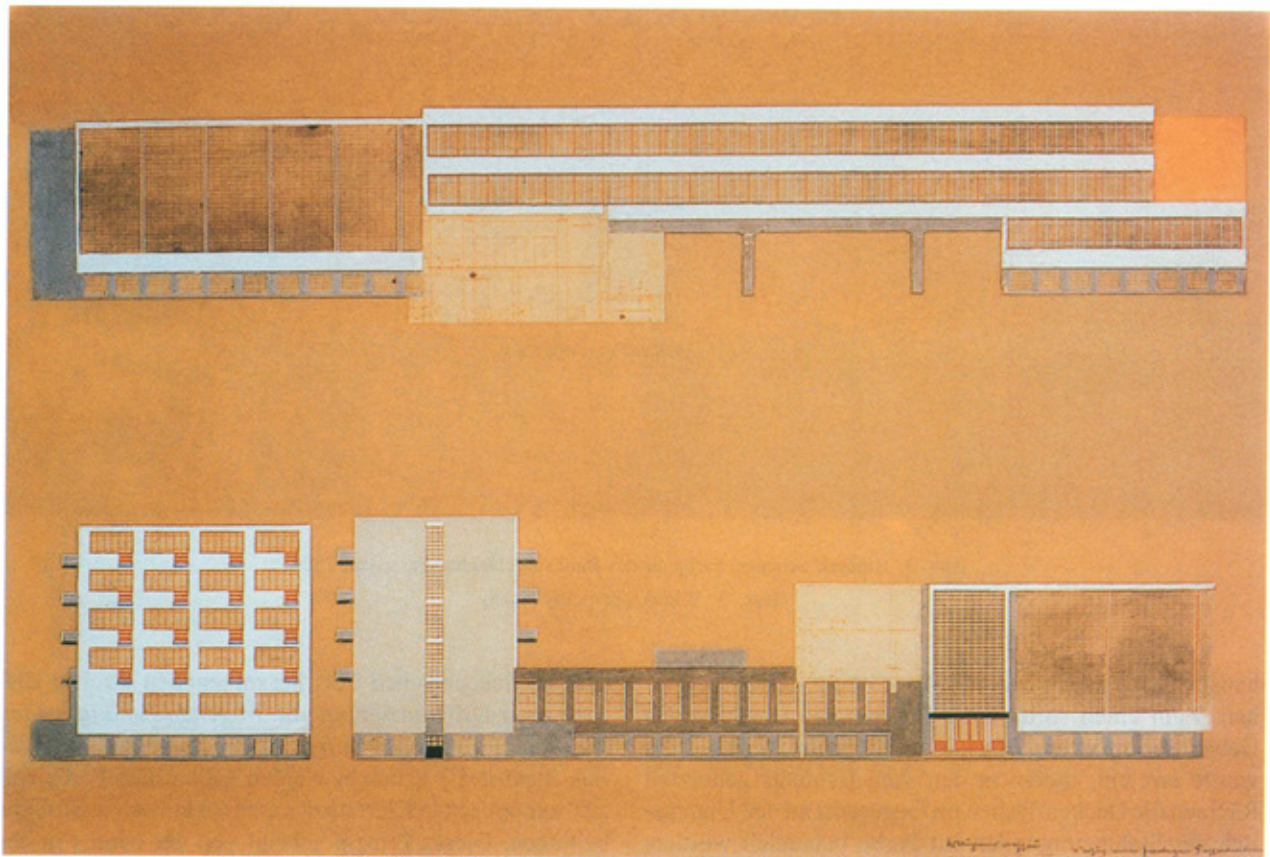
Hinnerk Scheper, Farbplan des Bauhausgebäudes, Fassaden, 1926
